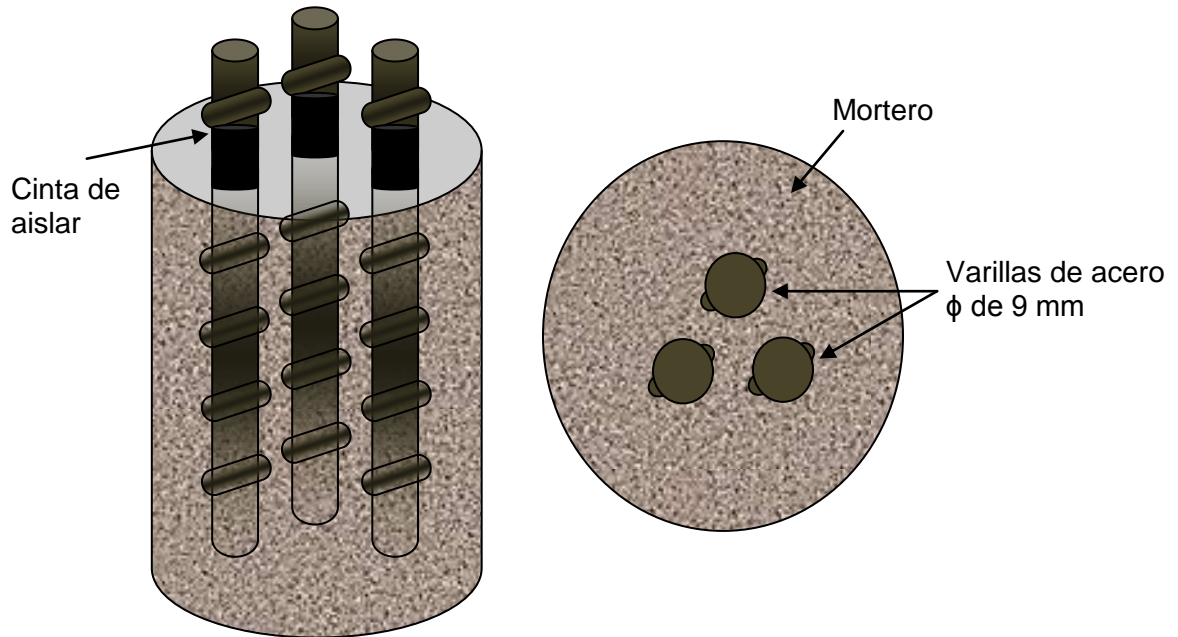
Esquema del montaje de las barras de acero dentro de un cilindro de mortero.
